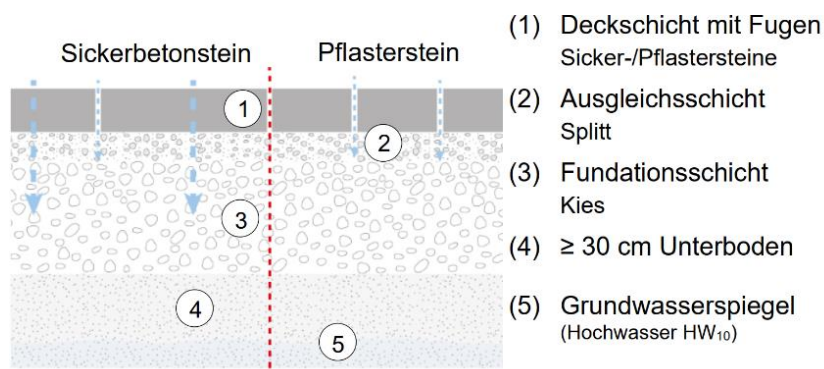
Schematischer Aufbau Sickerbetonsteine und Pflastersteine (Detail für Sommerhaldenstrasse vgl. Anhang)
